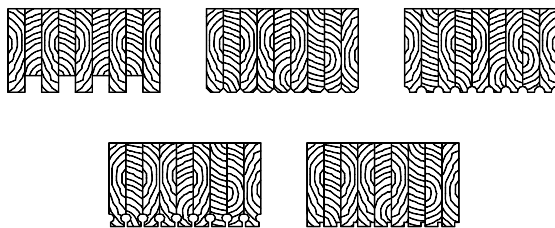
Secções transversais de lajes de madeira, Sandoz (2000)
